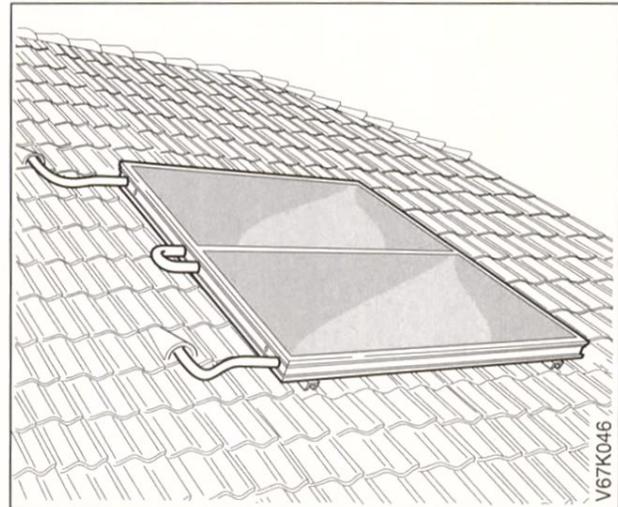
Ohne das Dach zu öffnen sind die Kollektoren sicher und schnell montiert.
